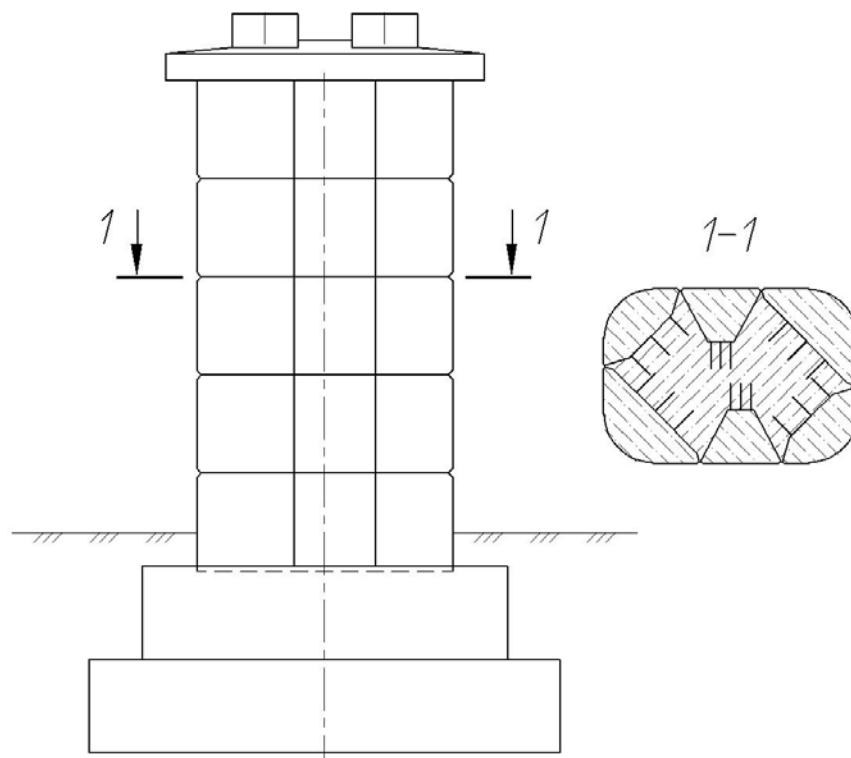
Опоры с контурными бетонными блоками с монолитным бетонным ядром.
